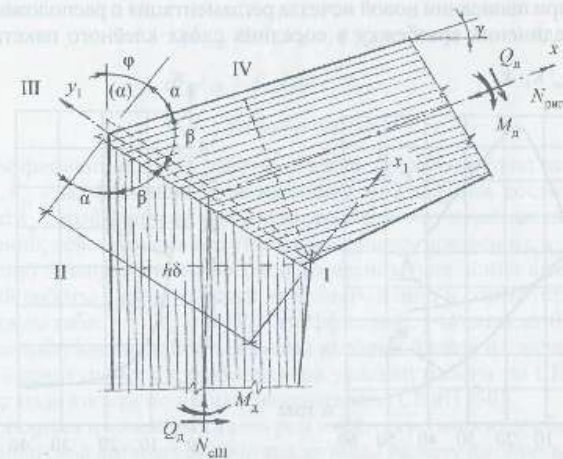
Расчетная схема узла с соединением ригеля и стойки на зубчатый шип под углом
